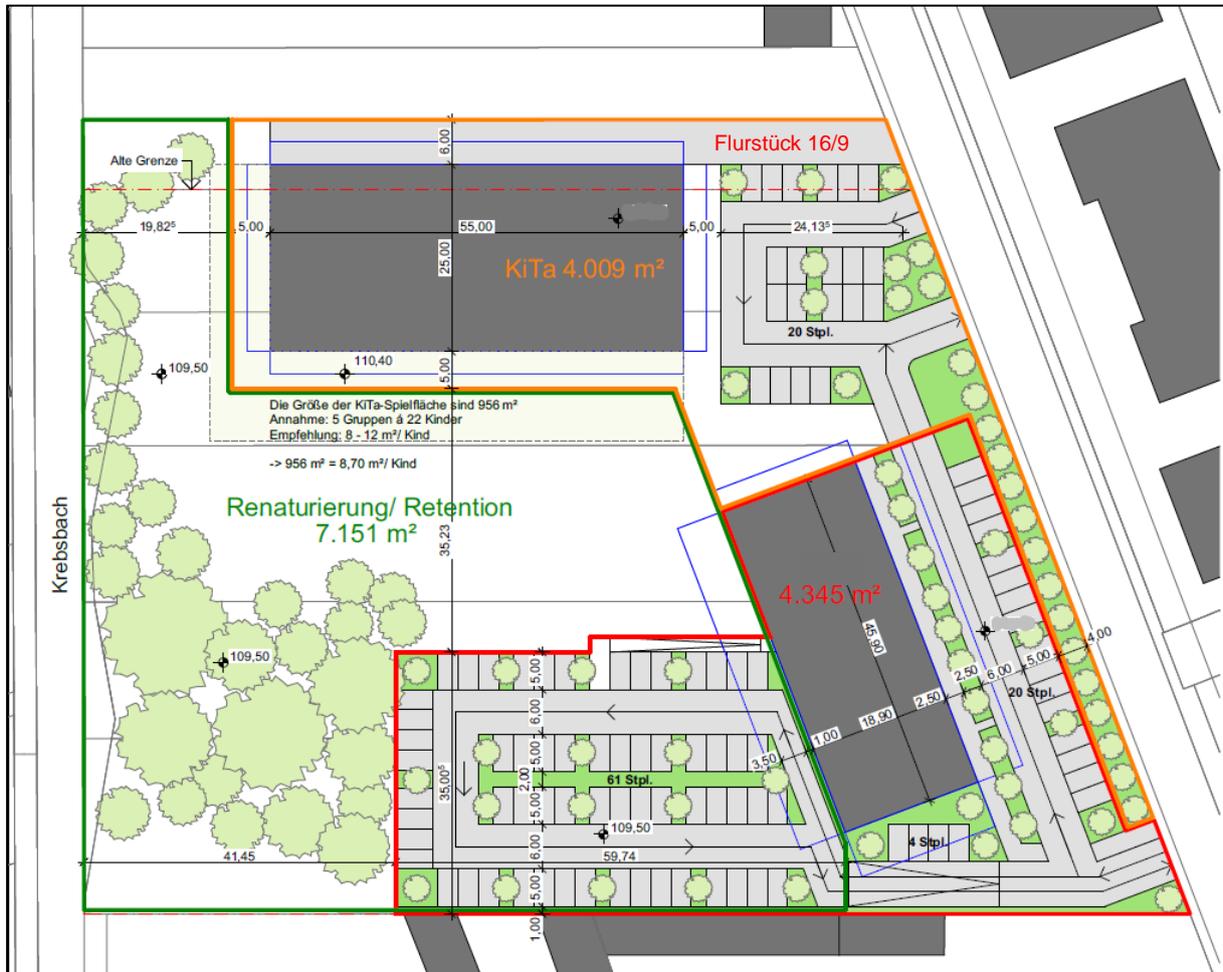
Lageplan der geplanten Baumaßnahme – Variante B
